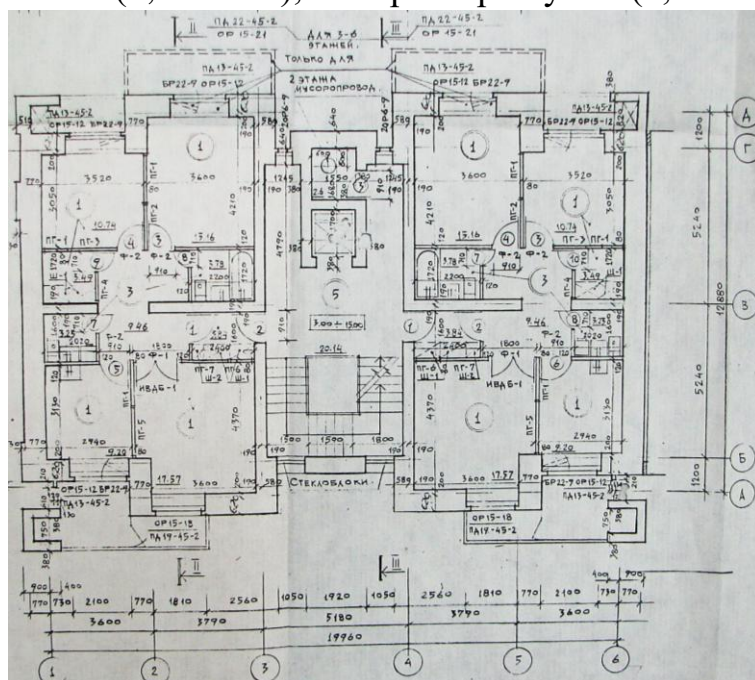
Дом-вставка по ул. Профсоюзов, д. 18. План типового этажа
